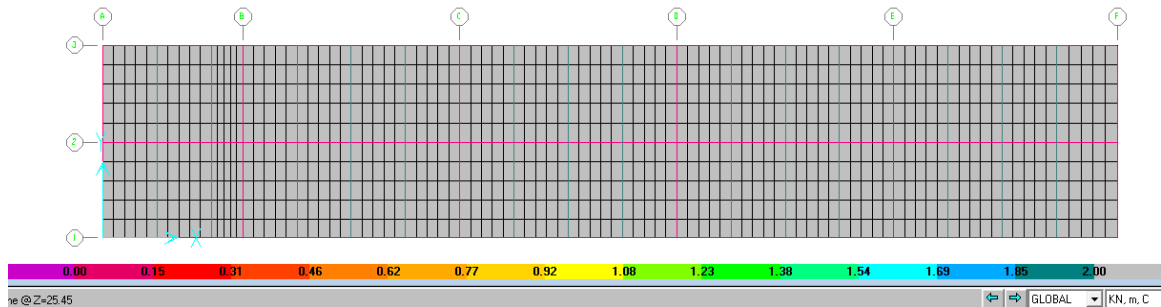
Planta nivel techo módulo de acceso estación 17 costado occidental aplicación de la carga viva (2,0 kN/m<sup>2</sup>)
